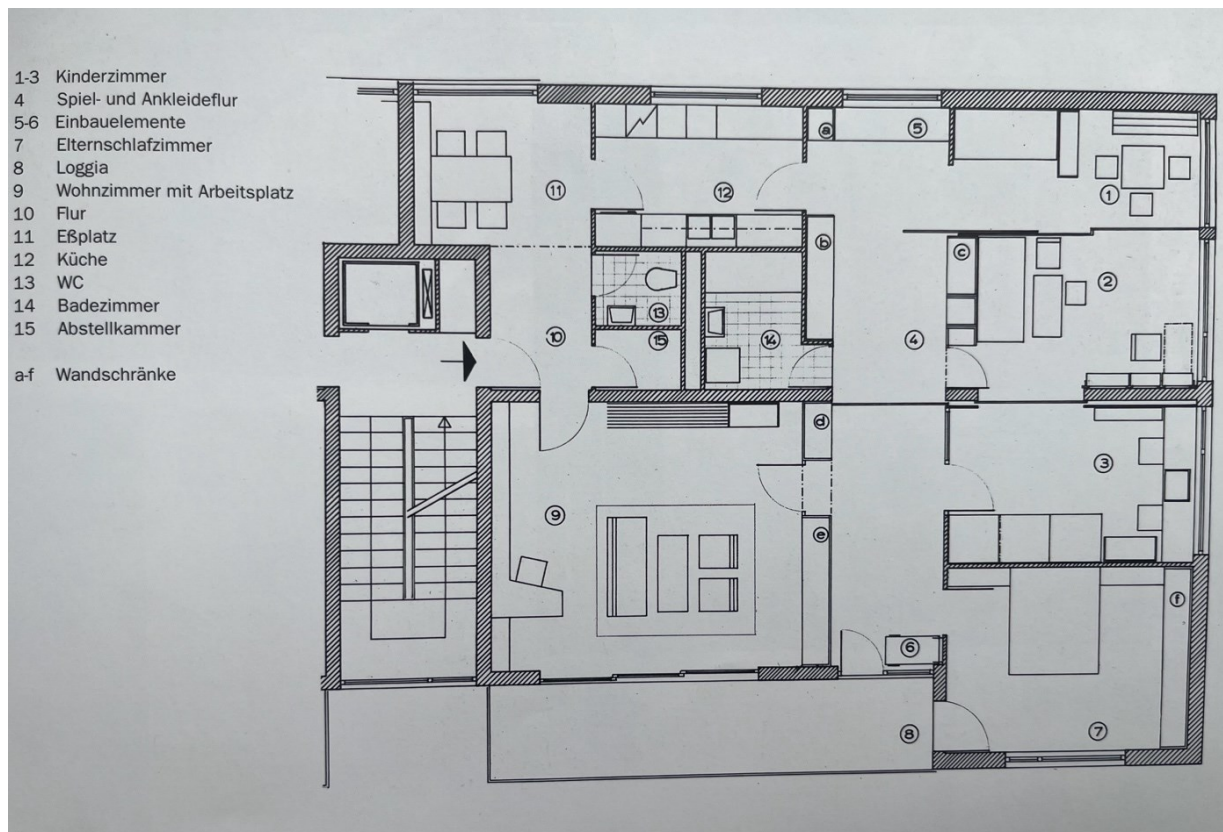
Hilde Weström, Grundriss des „Variablen Wohnraums“, 1957, Berlin.
